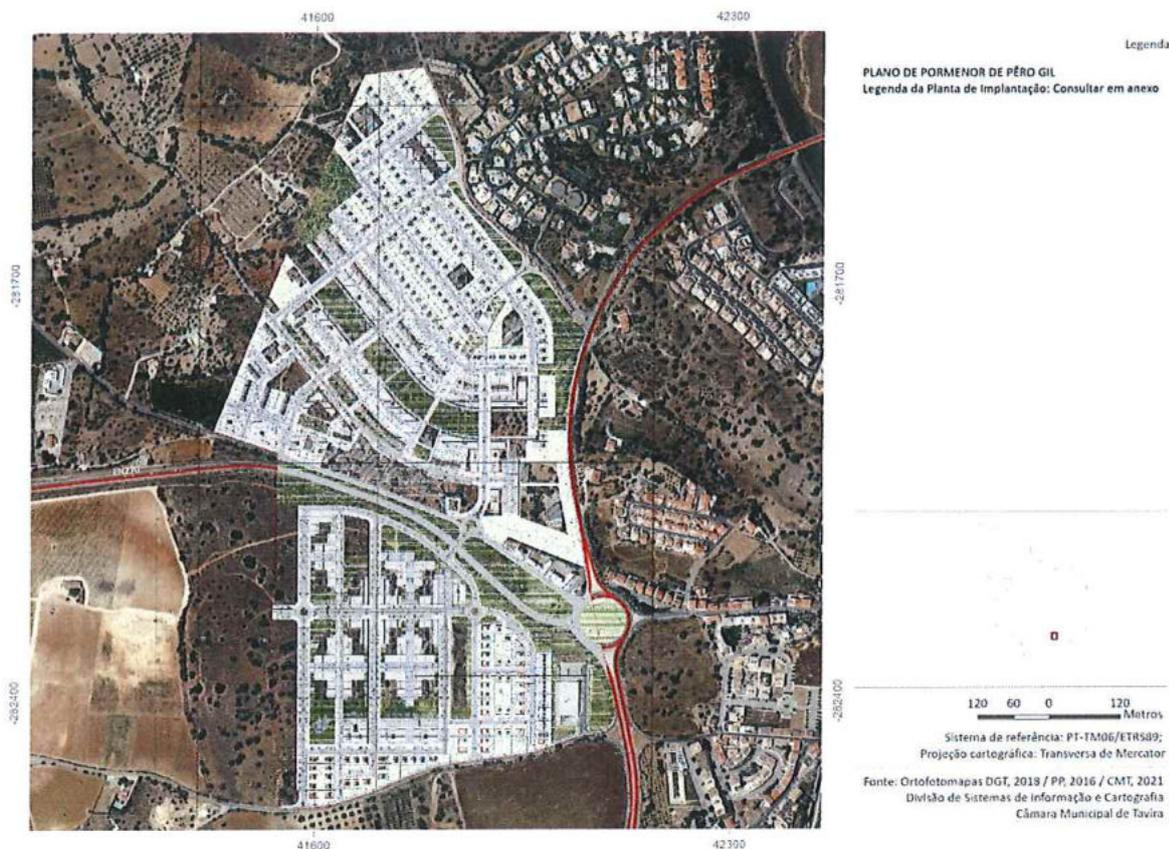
| Planta de Implantação do PP de Pêro Gil.
